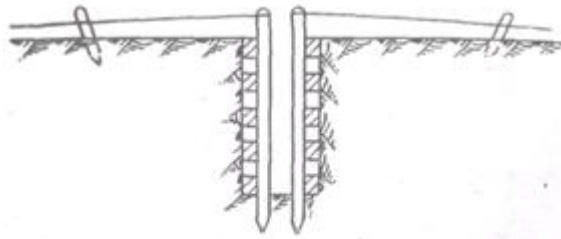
Крепление стен предохранительной траншеи, пройденной в сыпучих грунтах
